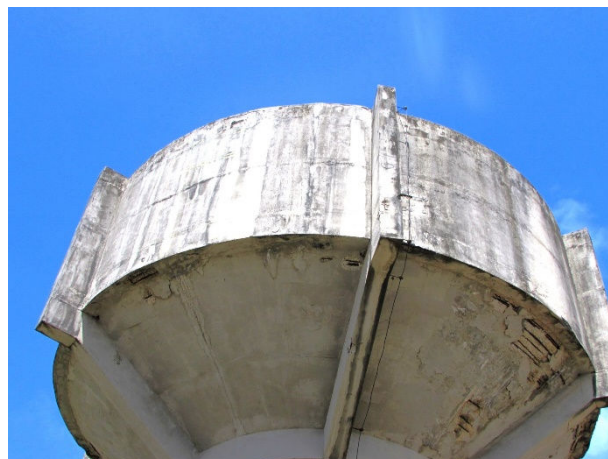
Vista geral da cuba (face sul) com manchas de umidade, corrosão avançada da armadura e deslocamento generalizado do concreto
